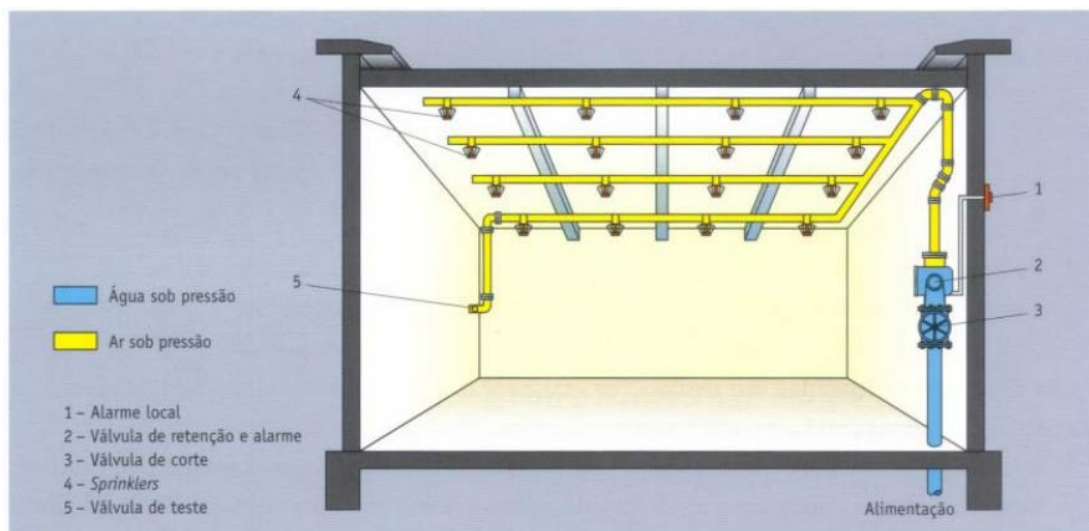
Instalação de *sprinklers* seca (*dry pipe system*) [50].
